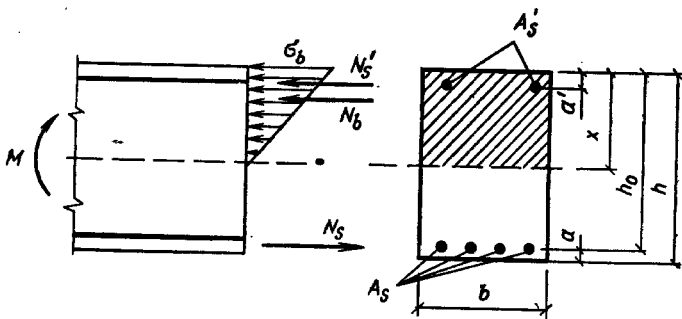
К расчету балки прямоугольного сечения по допускаемым напряжениям
